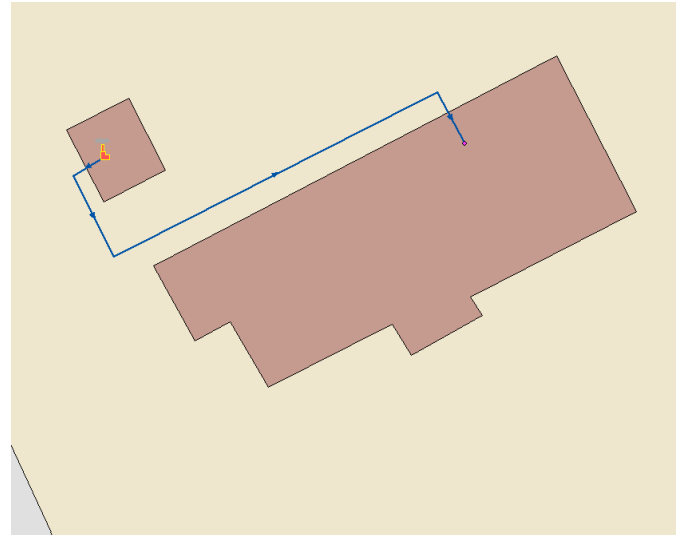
Схема тепловых сетей от здания котельной ул. Рубежная, дом №7
